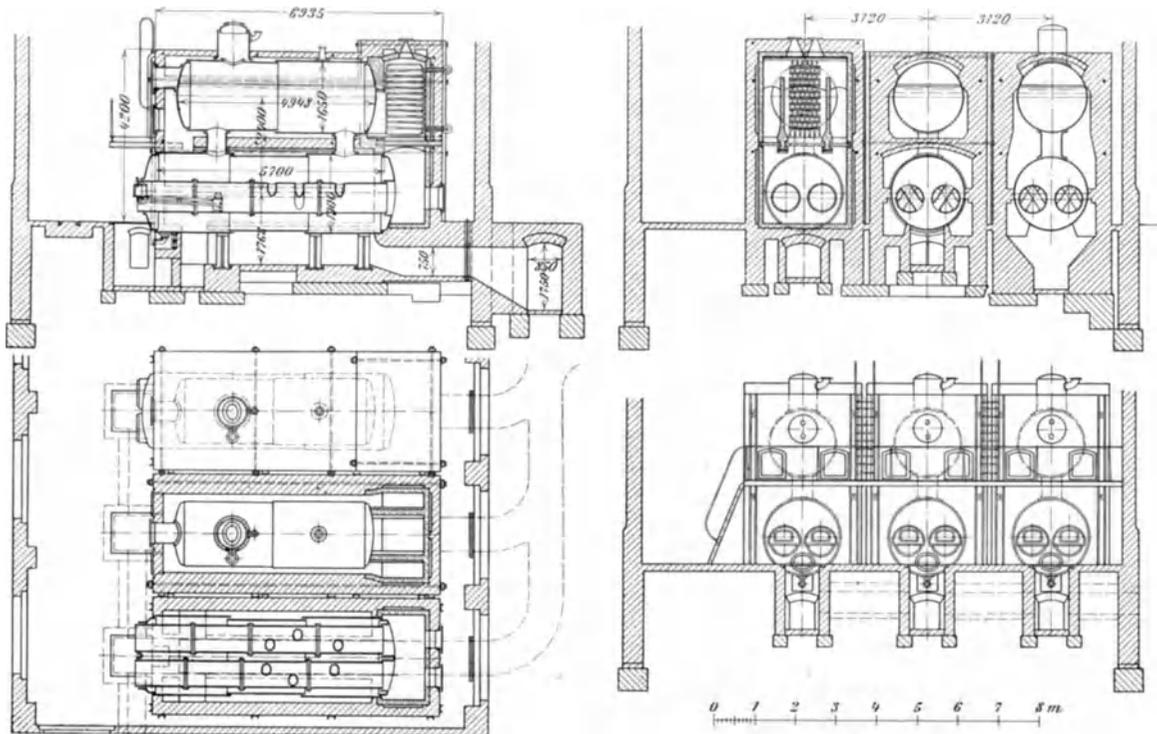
Grundrisse und Schnitte der Dampfkesselanlage im Kesselhause.
